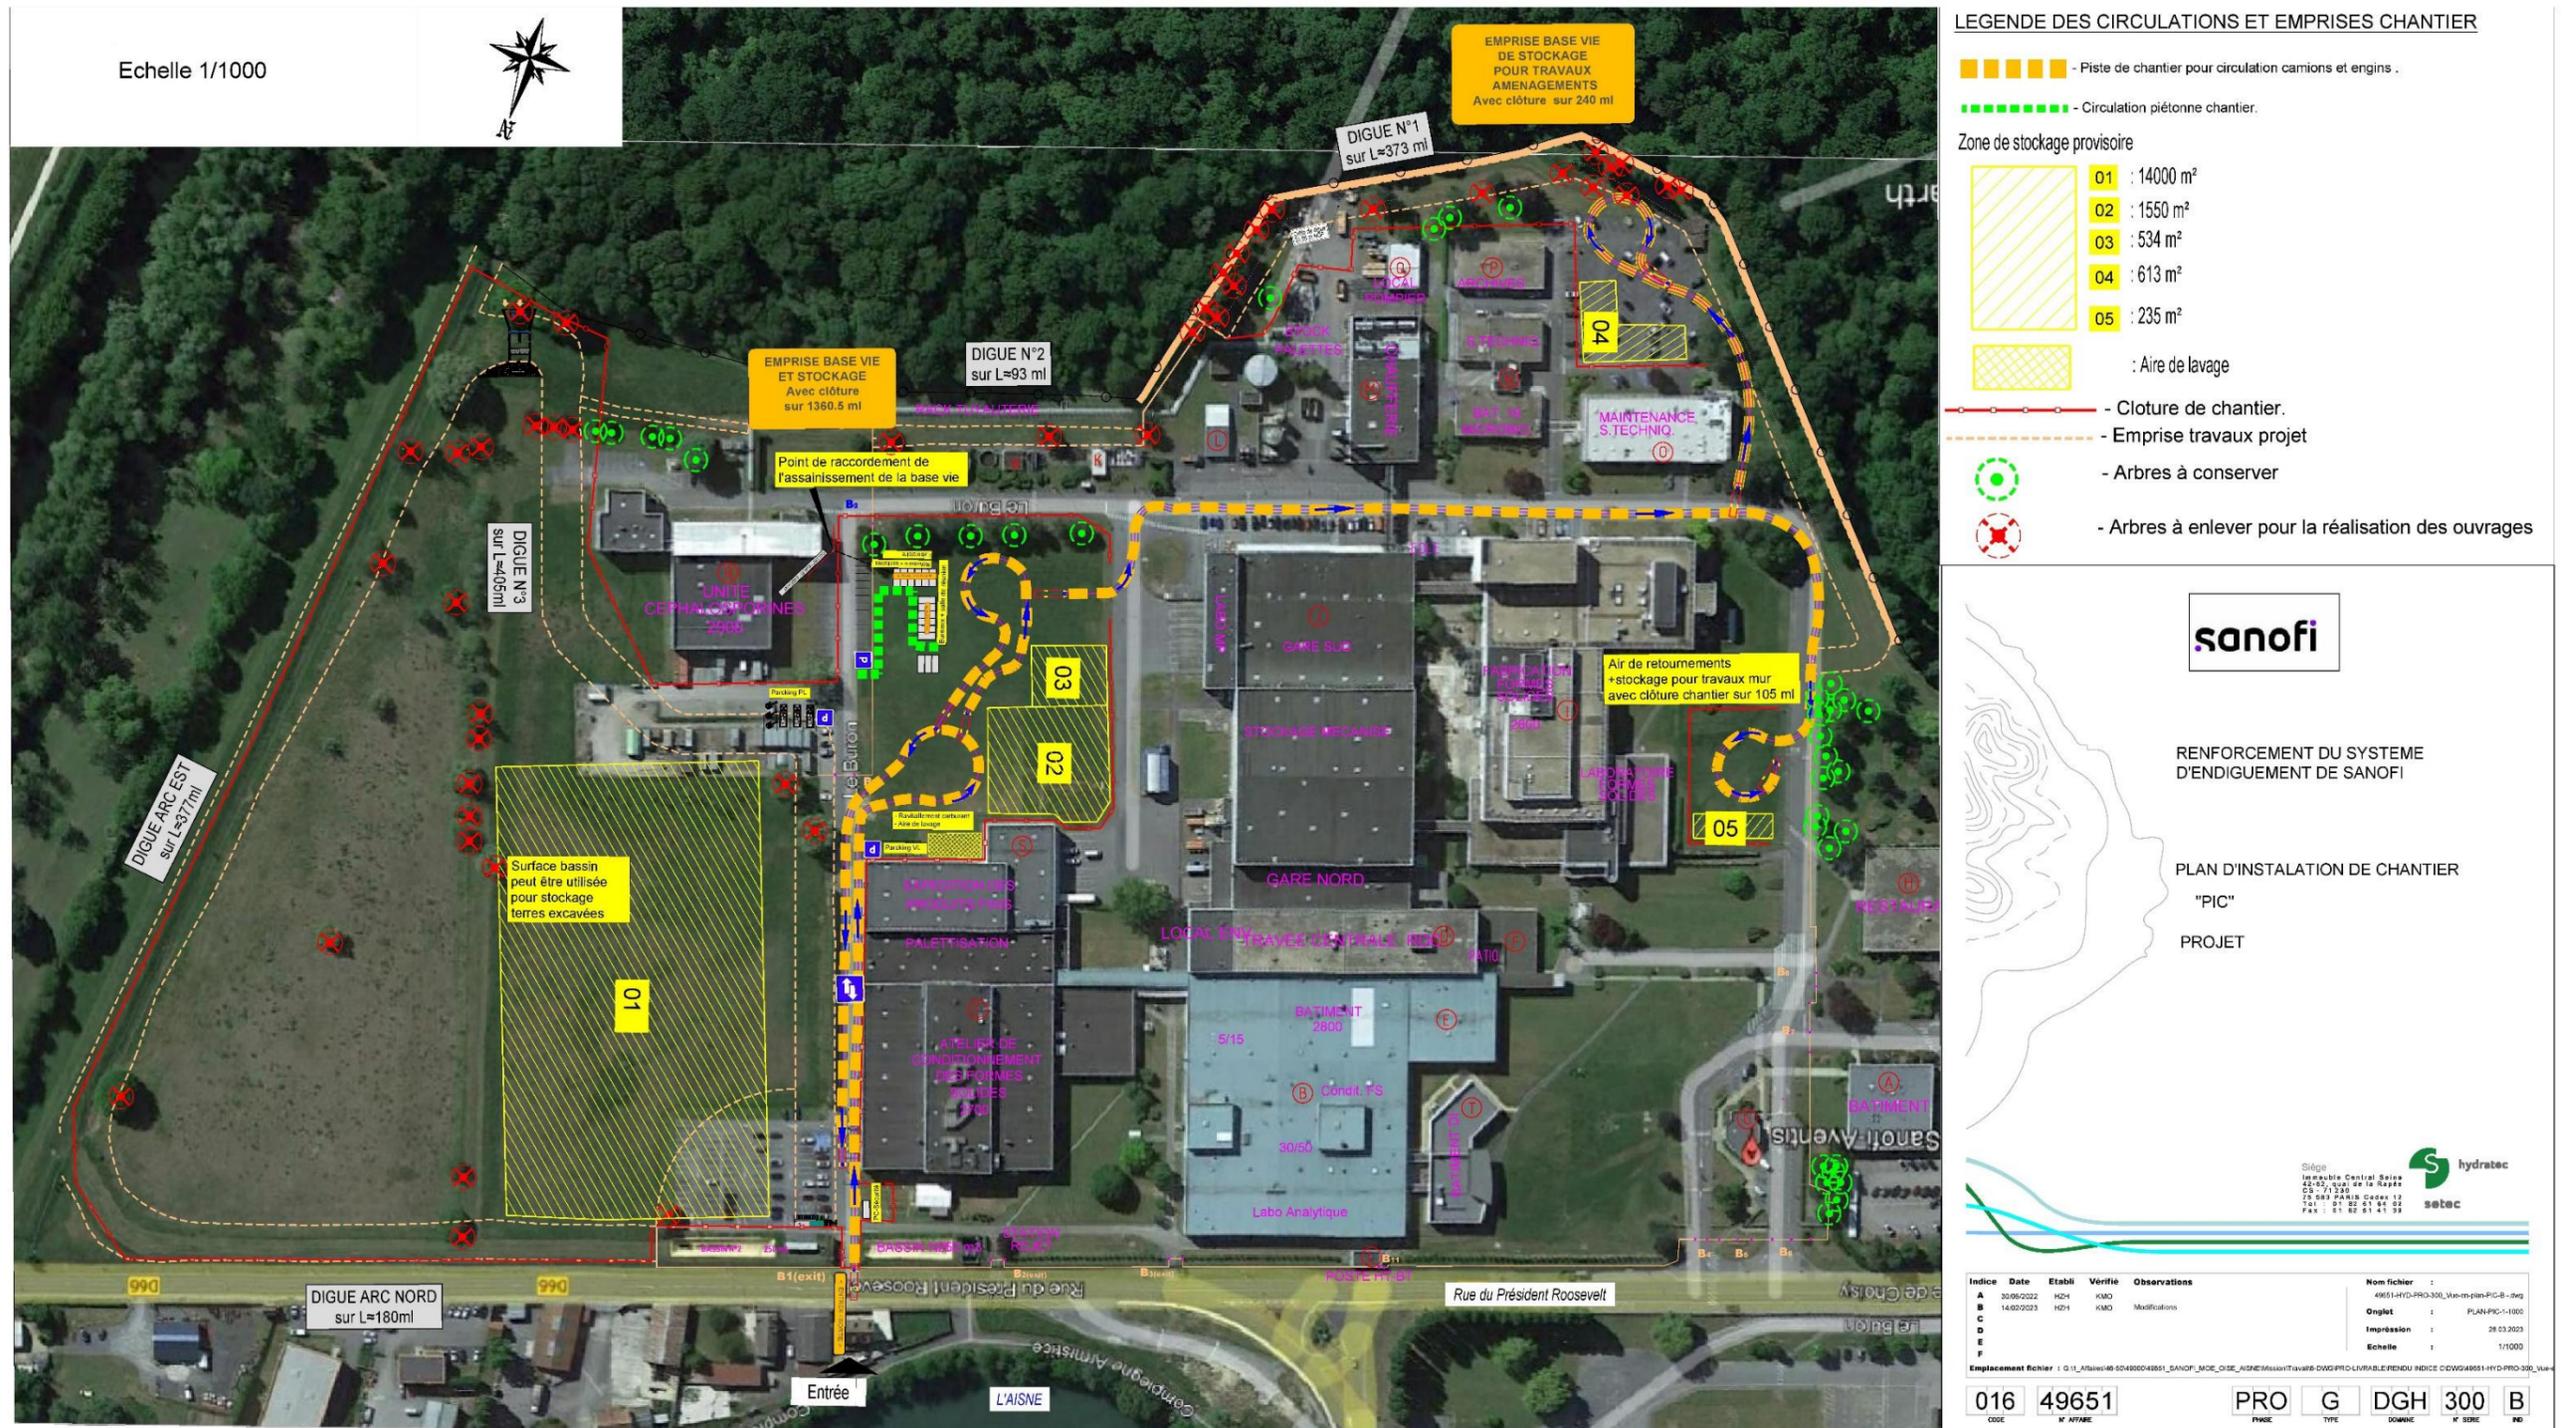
Plan d'installation de chantier et de circulation du projet de renforcement du système d'endiguement de SANOFI
